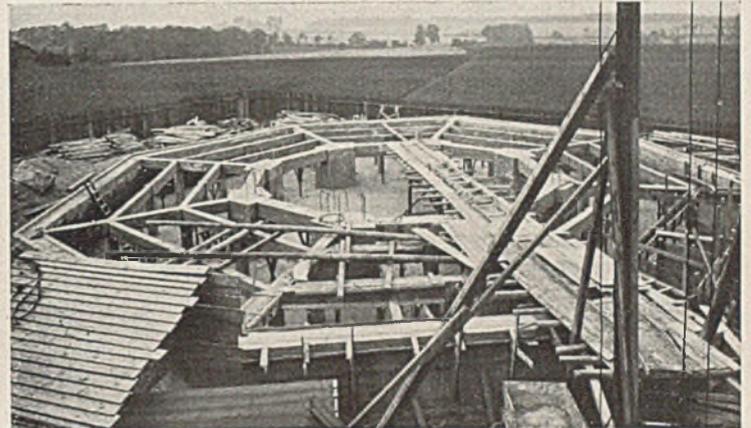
Fertiger Kühlturmunterbau in Eisenbeton.
